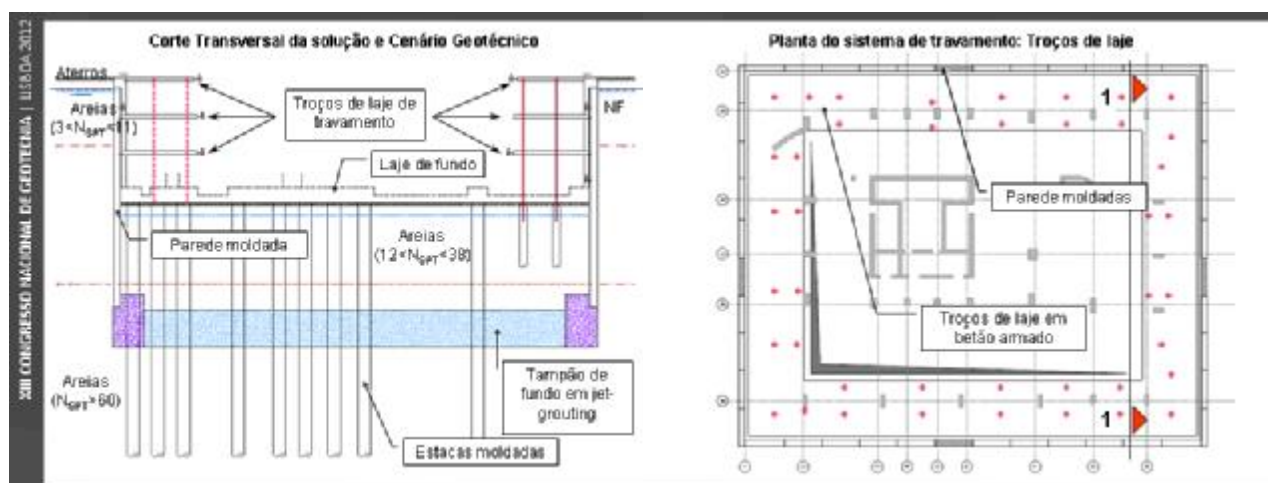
Corte transversal da solução e cenário geotécnico. Planta do travamento – troços de laje.
